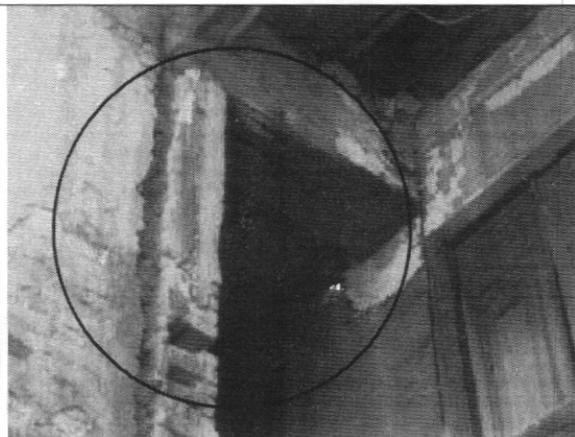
Desprendimiento de unidades de mampostería en muros de segundo piso
